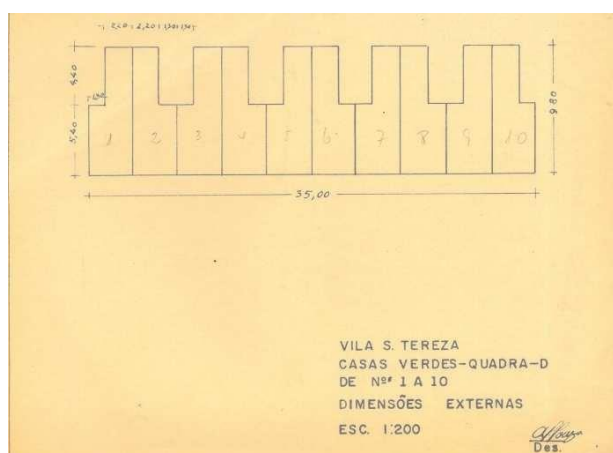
Planta baixa das casas verdes. Fonte: Biblioteca SUPRG.
